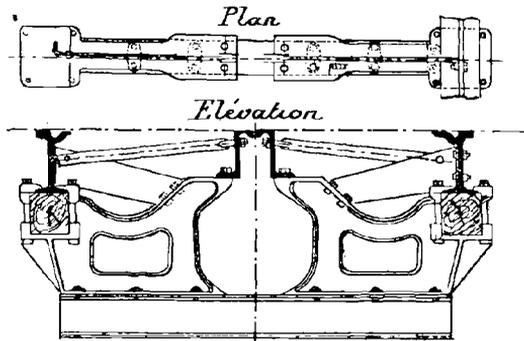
Caniveau de la Third Avenue. — Traverse, élévation et plan.
